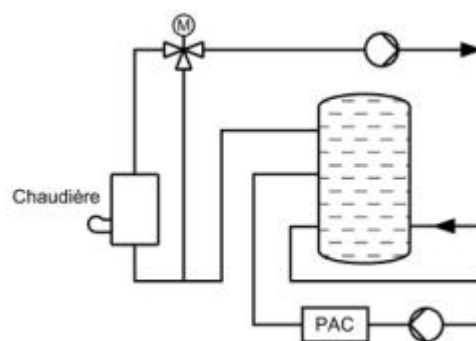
Exemple de montage de PAC en relève de chaudière avec raccordement sur ballon tampon sur le retour
